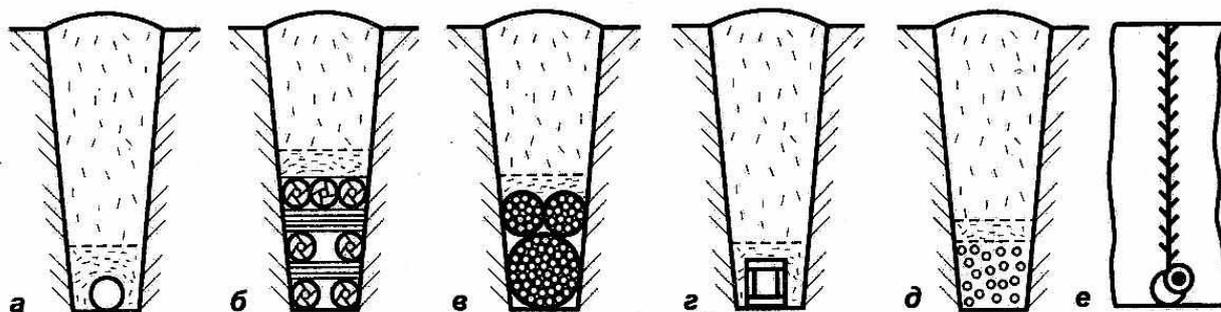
Виды дренажа: а - гончарный; б – жердяной; в – фашинный; г – деревянный трубчатый; д – каменный; е - кротовый
